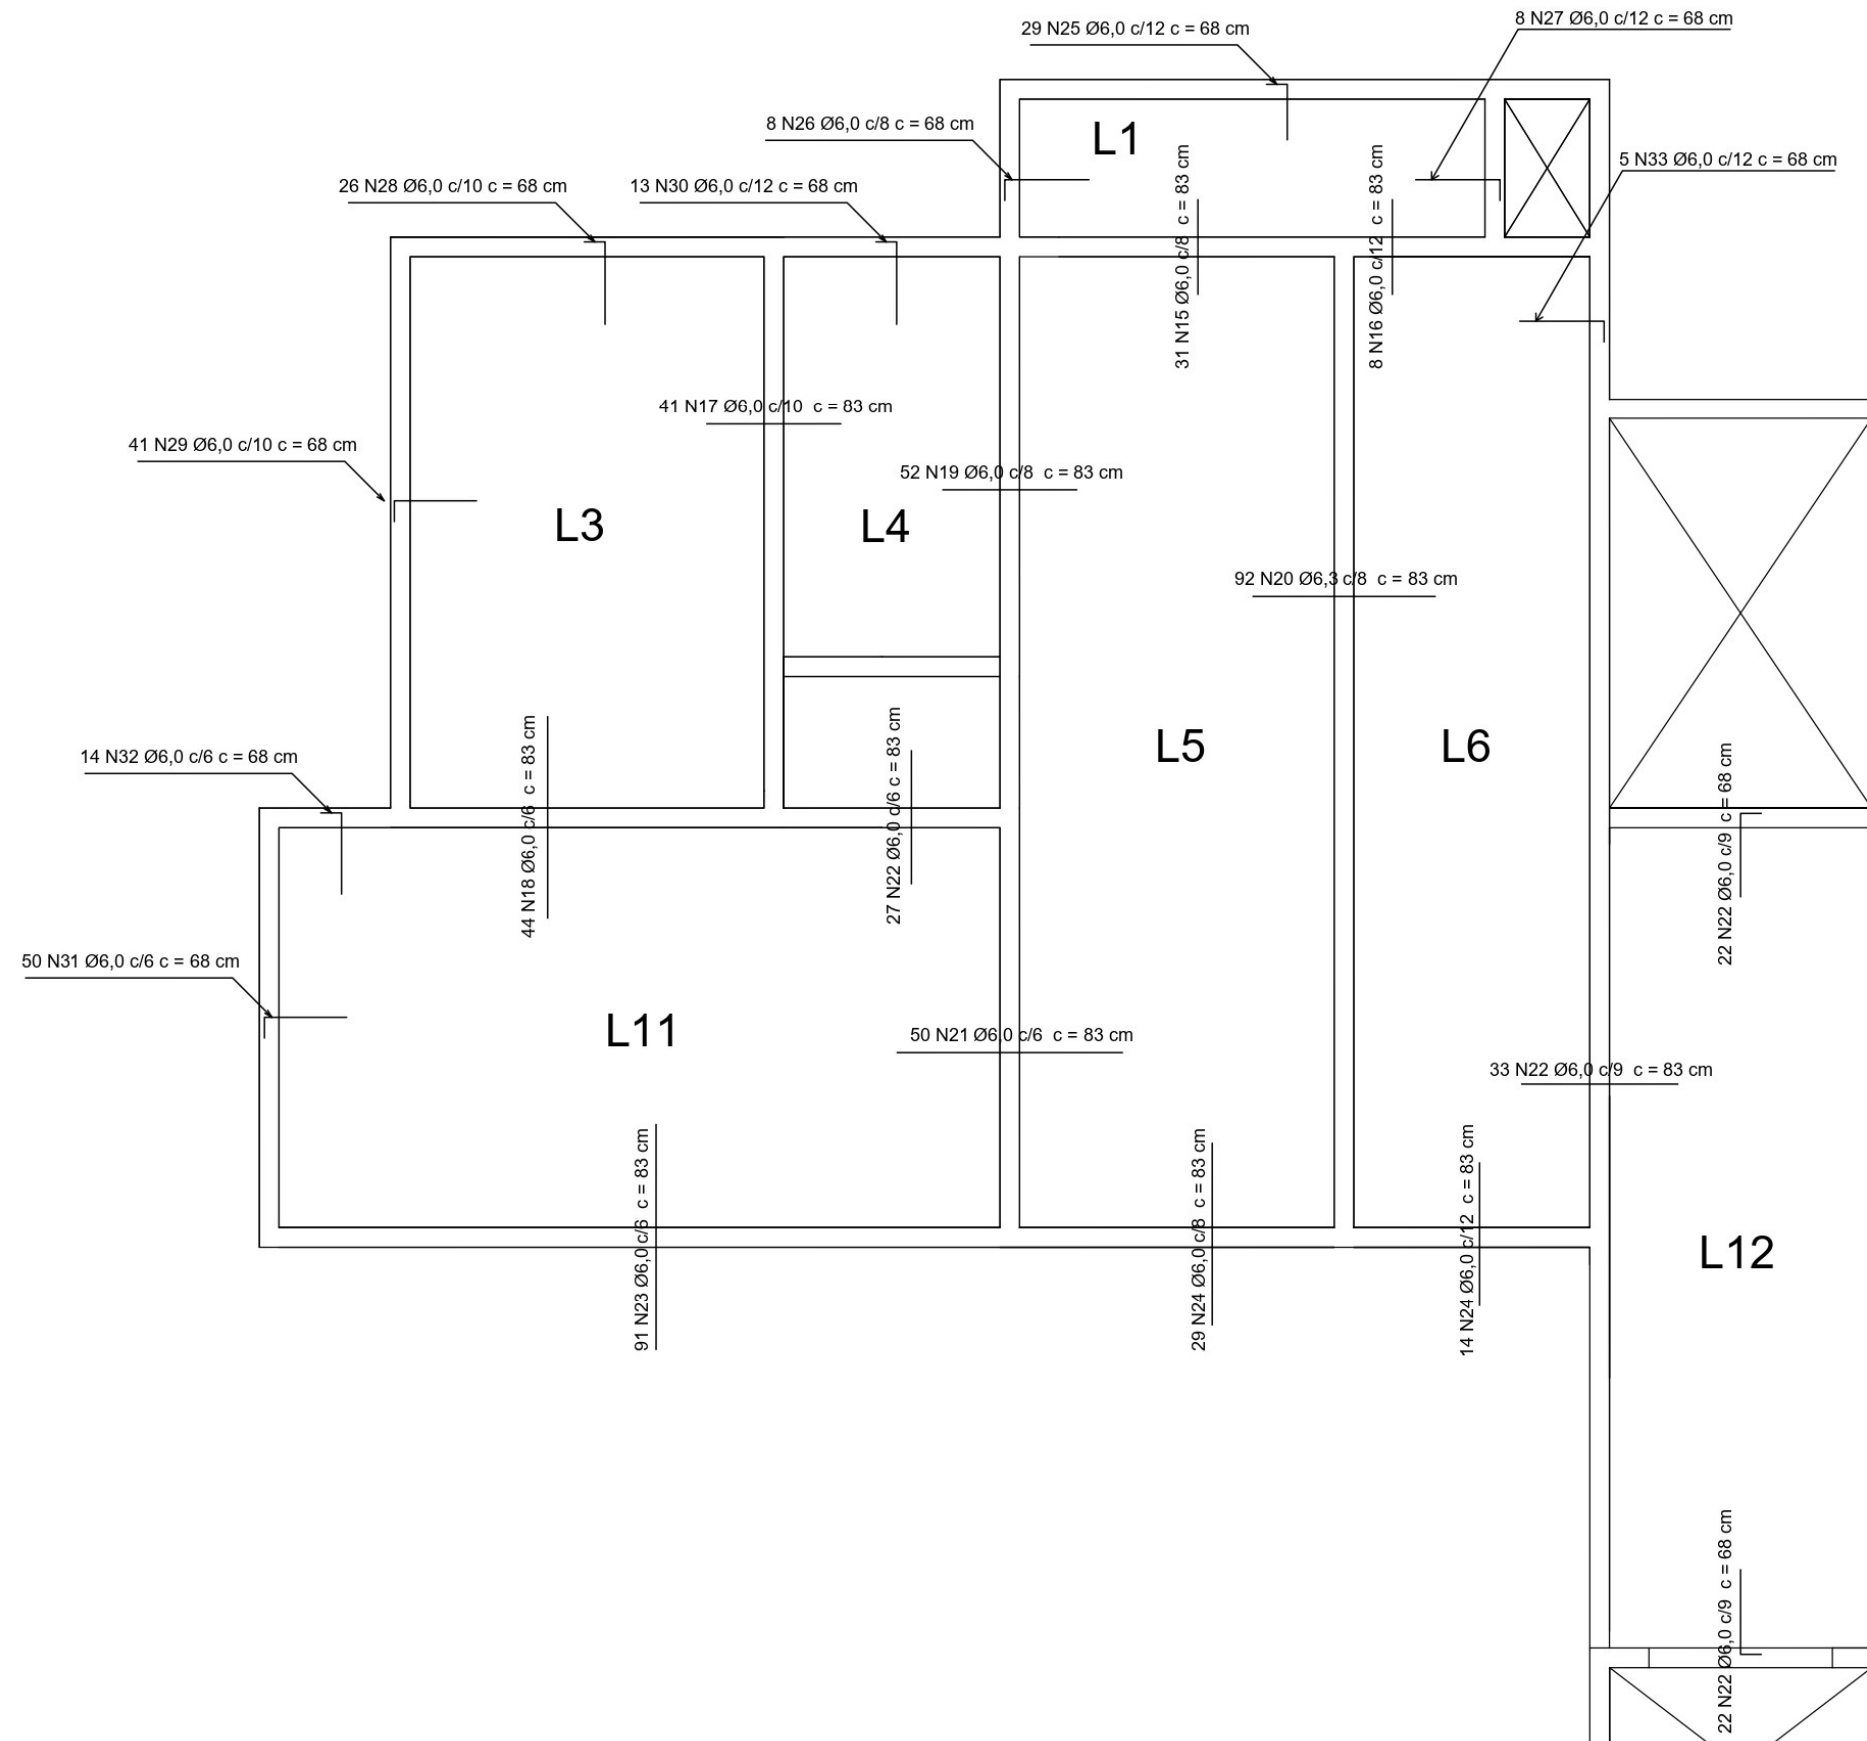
Planta de armadura de flexão negativa das lajes armadas com BFRP
